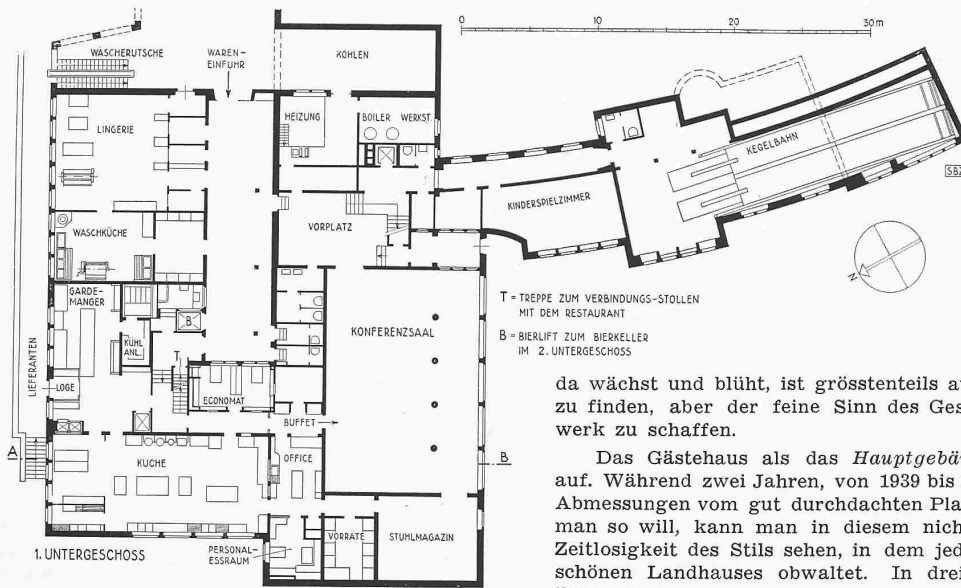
Grundriss des ersten Untergeschosses. 1 : 500
